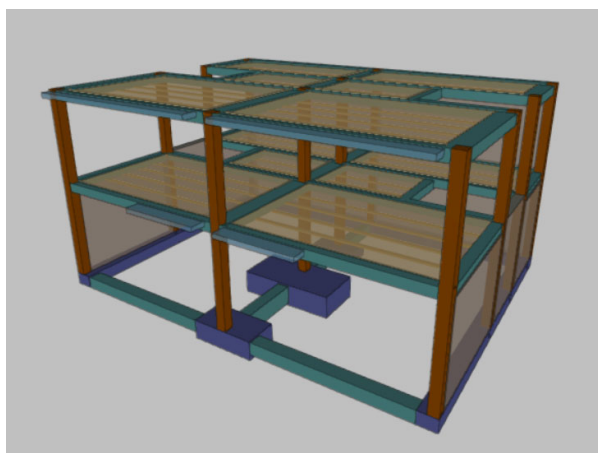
Estructura de la vivienda pareada en CYPECAD en hormigón.
